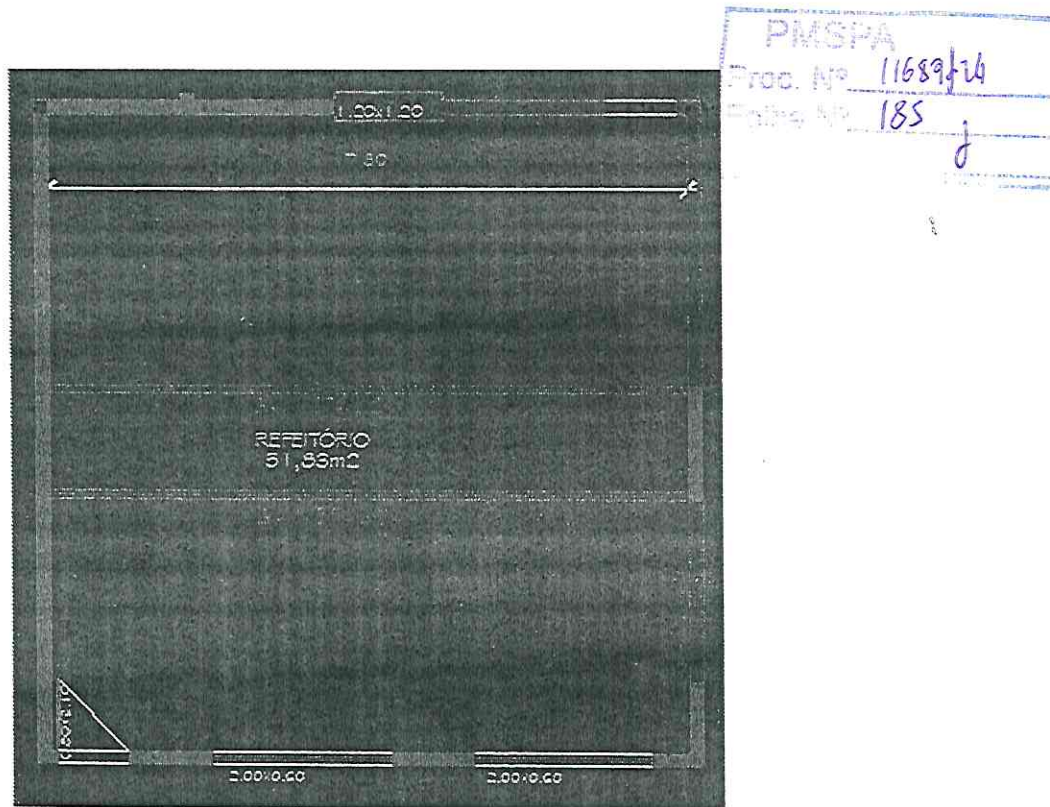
Configuração do refeitório que terá vigas de reforço no teto
